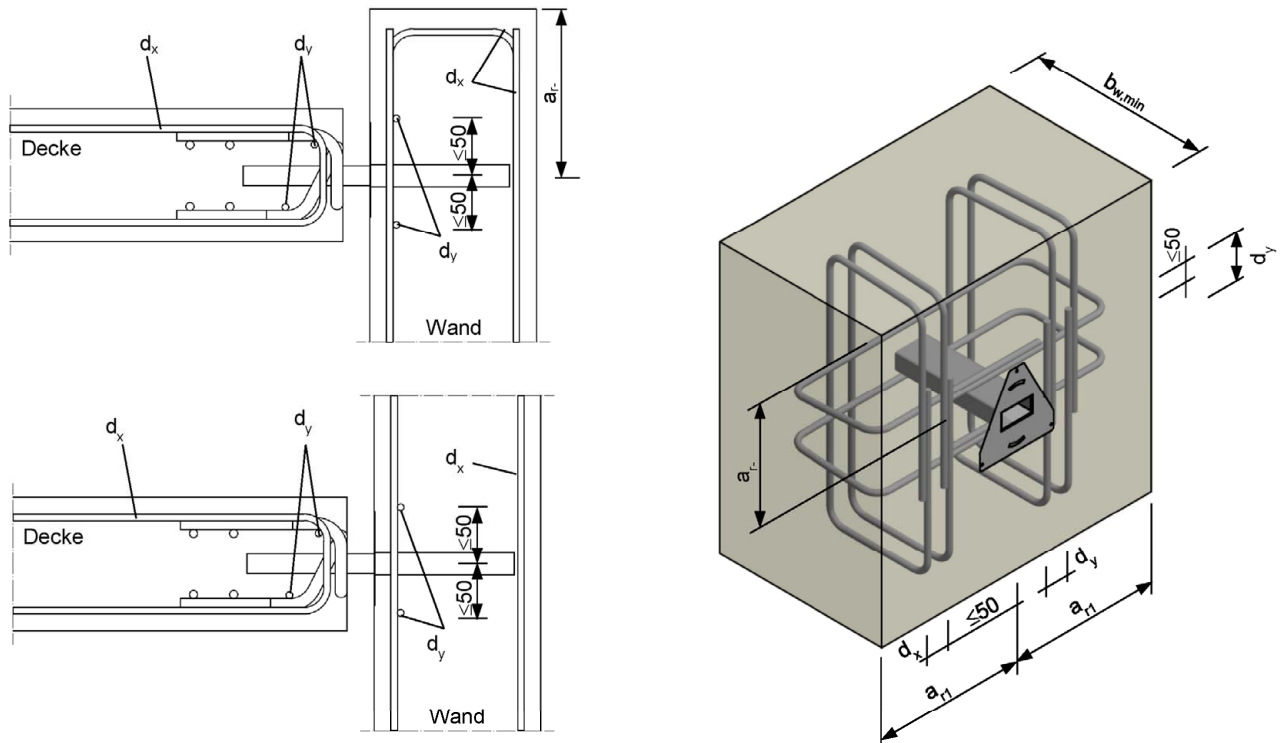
Wandeinbau mit einem Ankerkörper in der Decke
